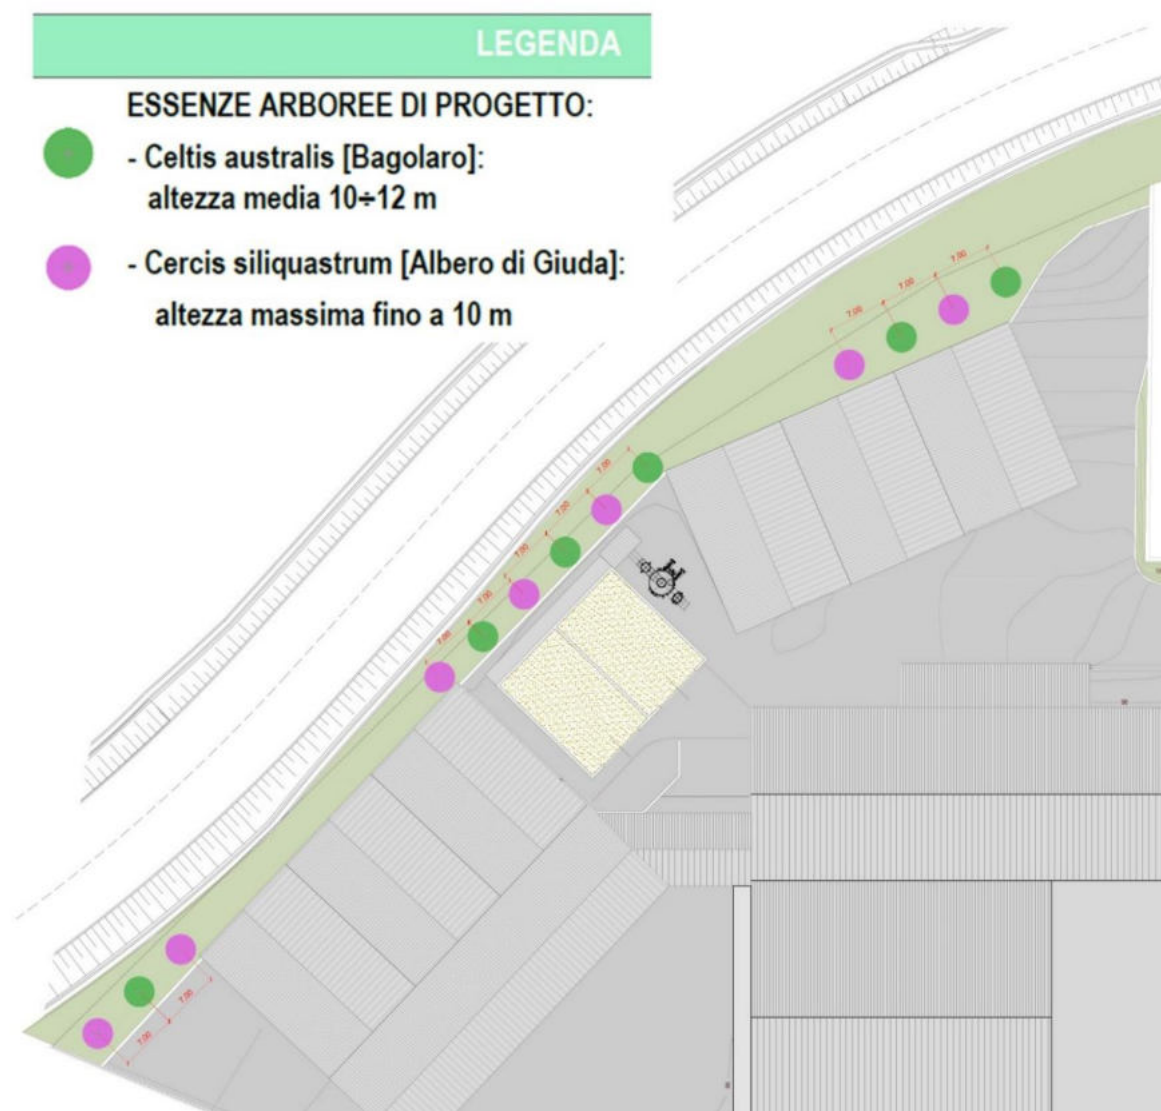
STRALCIO PLANIMETRIA GENERALE DI PROGETTO – Nuove piantumazioni
